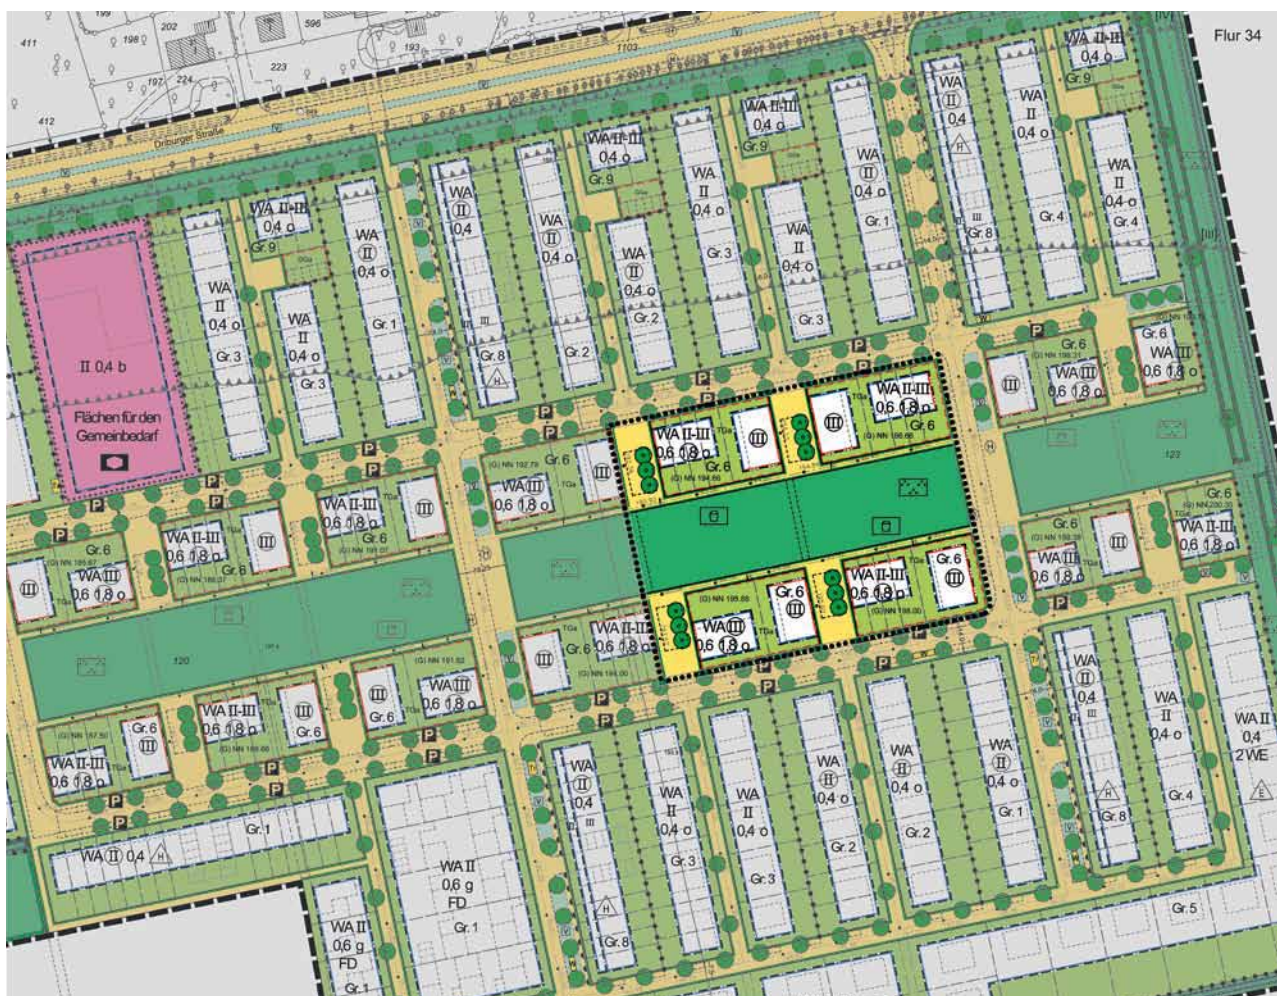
Klimaschutzsiedlung im Bebauungsplan
